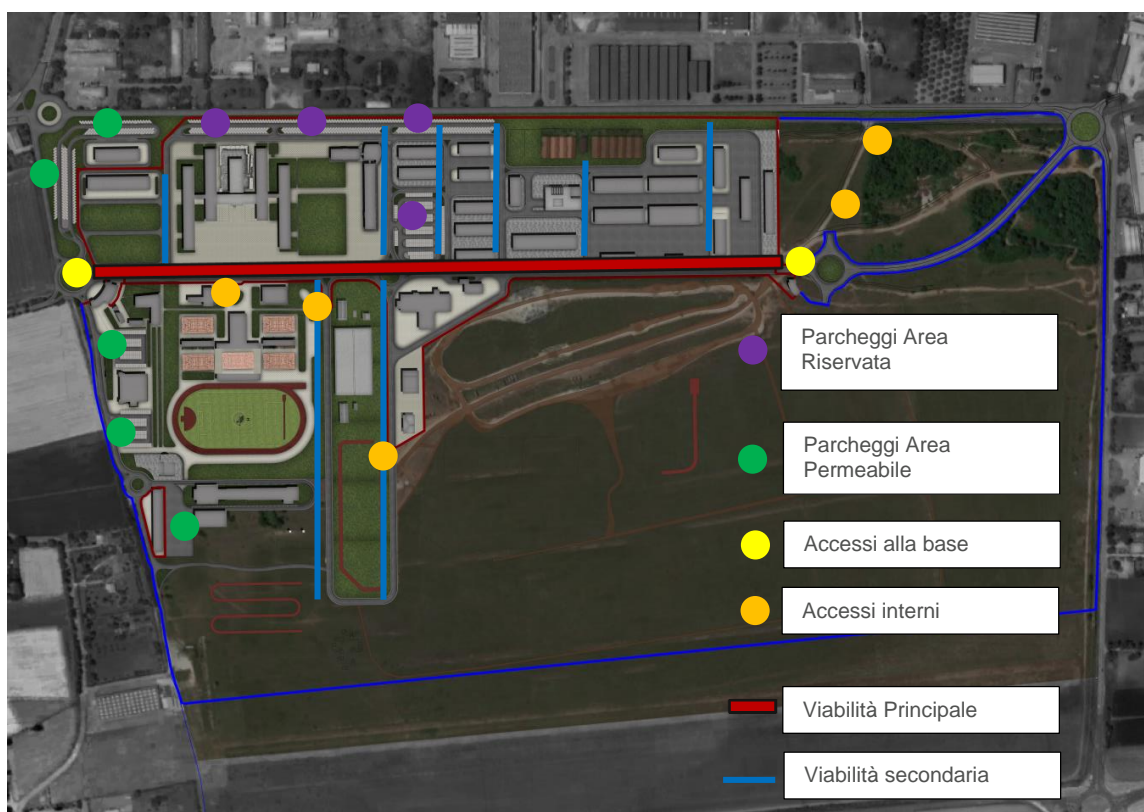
Planimetria Generale di Progetto. Schema Dual Use
